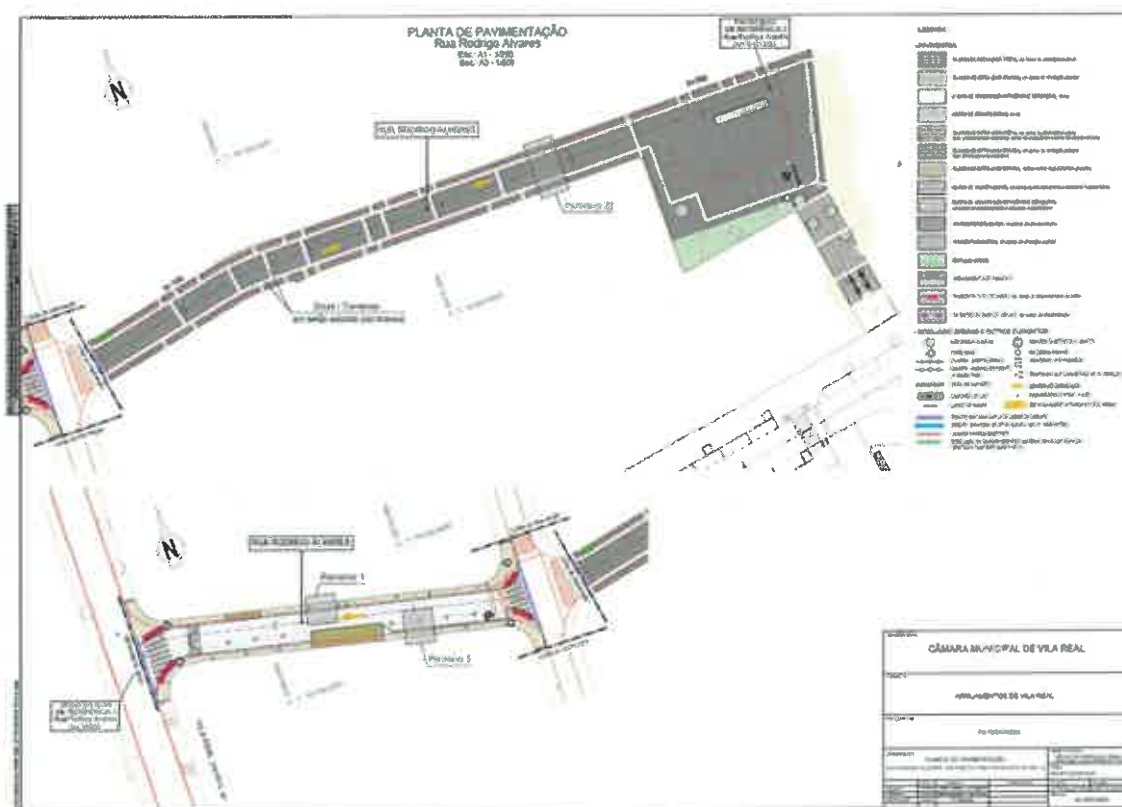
Planta da intervenção da rua Rodrigo Álvares
